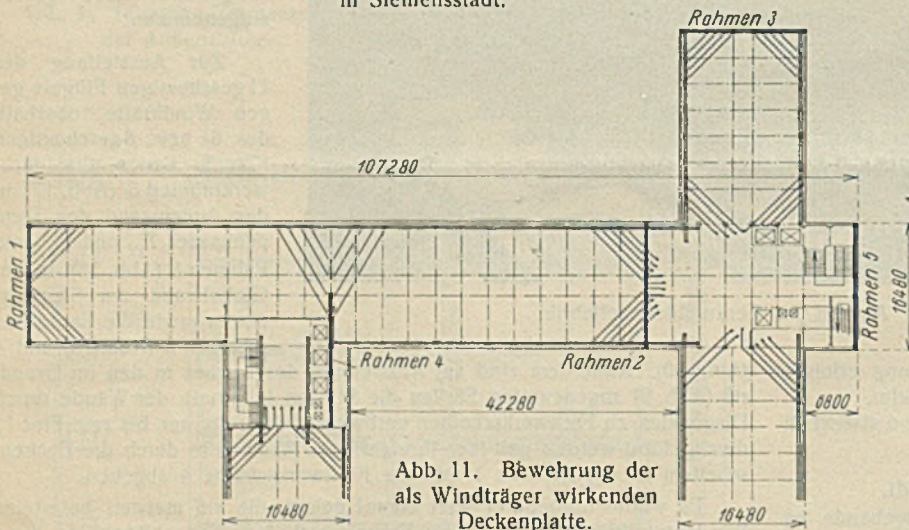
Bewehrung der als Windträger wirkenden Deckenplatte.
